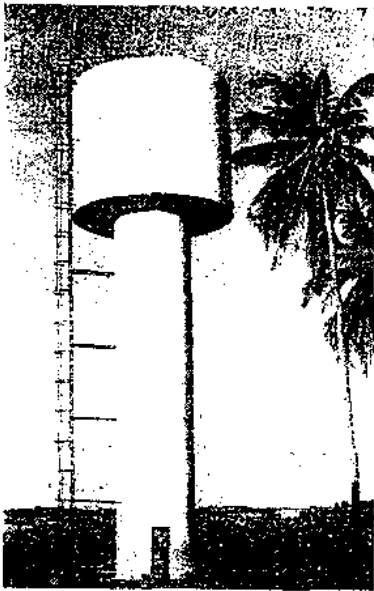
Estanque elevado de concreto. Sinamaica, Estado Zulia. Venezuela.
